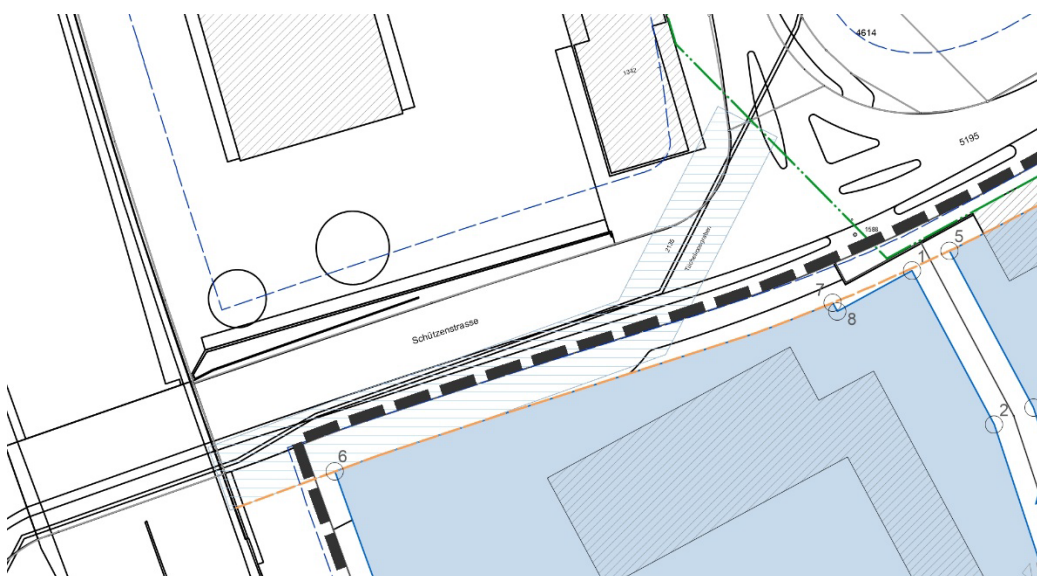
Ausschnitt aus Situationsplan, Lage Gewässerraum
